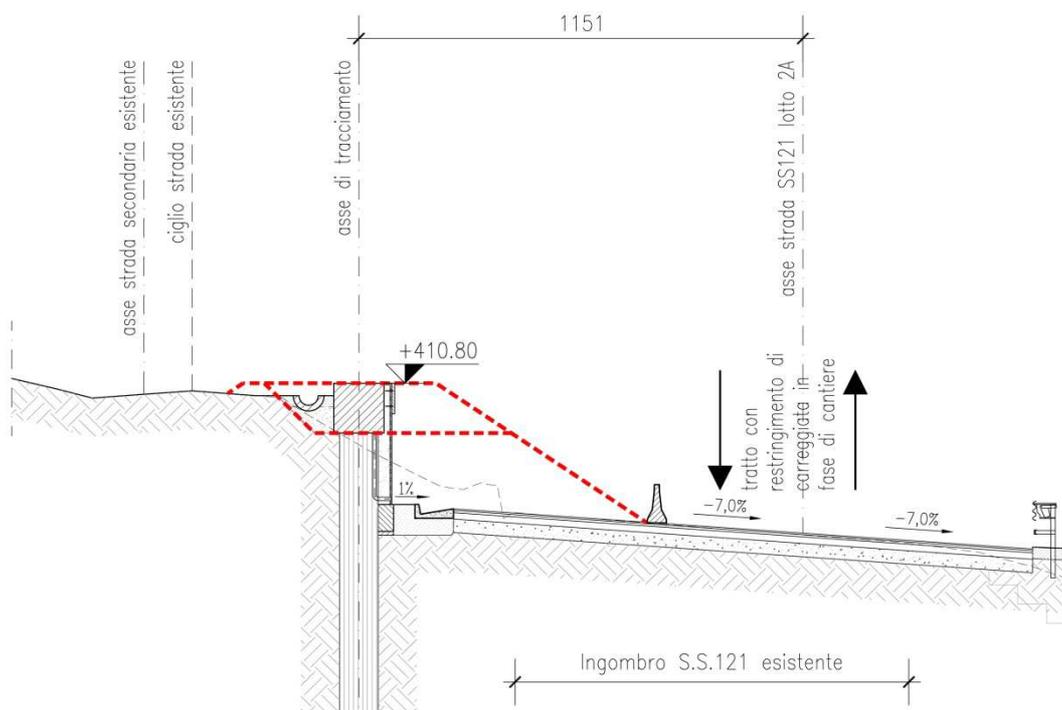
Pista di cantiere interferente con la SS121 come da Progetto Esecutivo Approvato (PEA)
